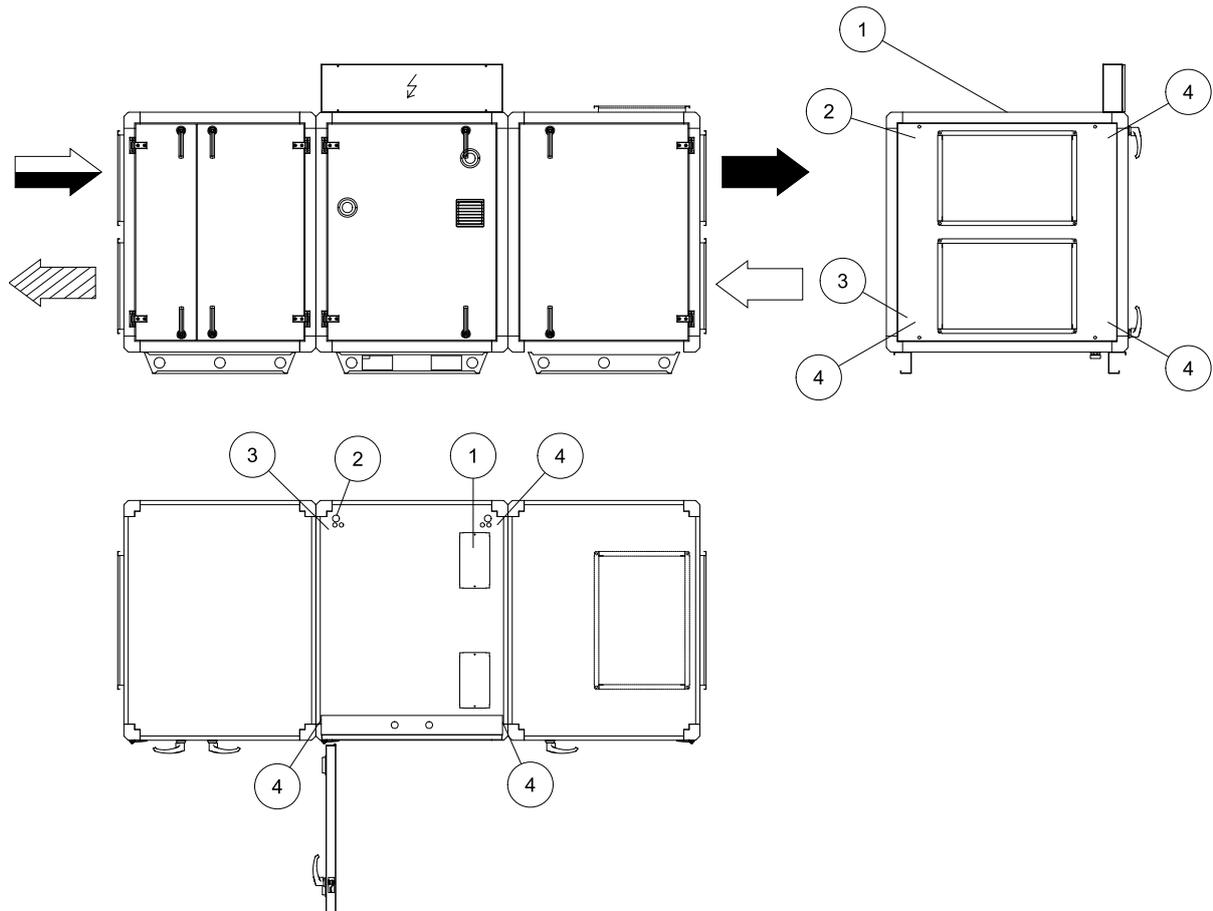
Левосторонний агрегат (если используется правосторонний агрегат, нужно зеркально отобразить рисунок)
